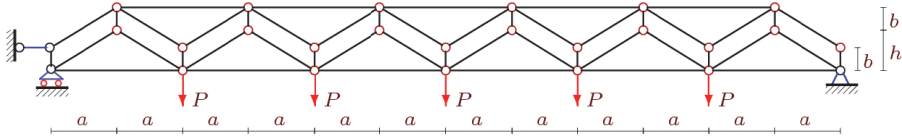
Ферма при $n = 3$. Нагрузка на нижний пояс
